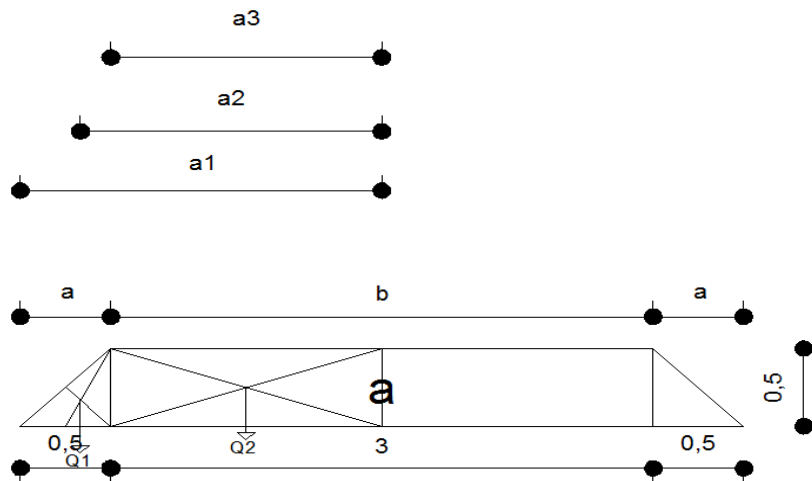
Potongan Melintang Plat Lantai Kendaraan
